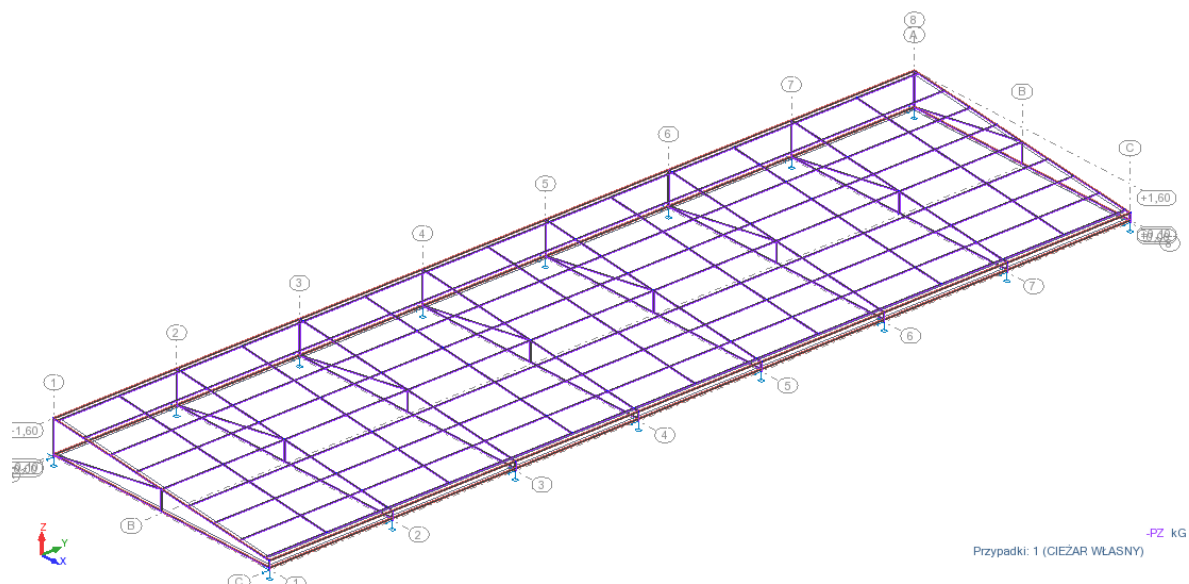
Część II - Widok konstrukcji dachu – widok z boku
